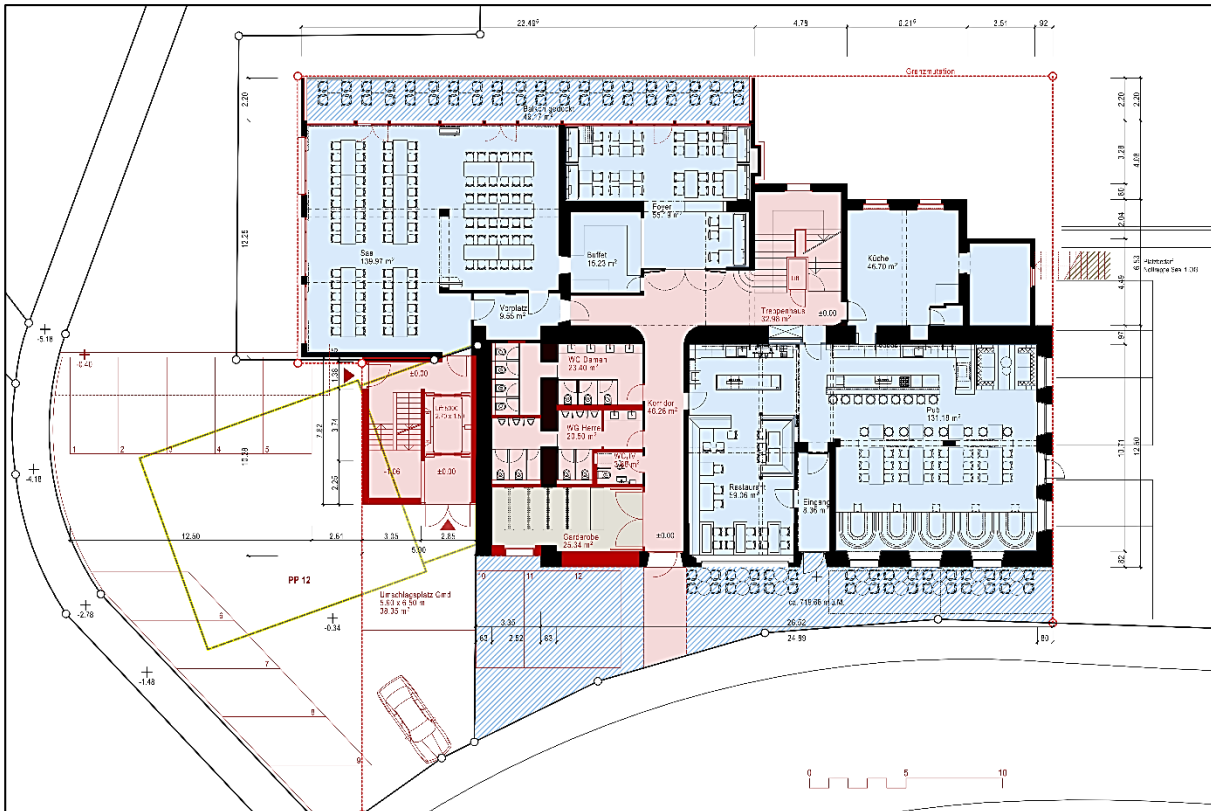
Grundriss Erdgeschoss, Stand: 18.10.2022
